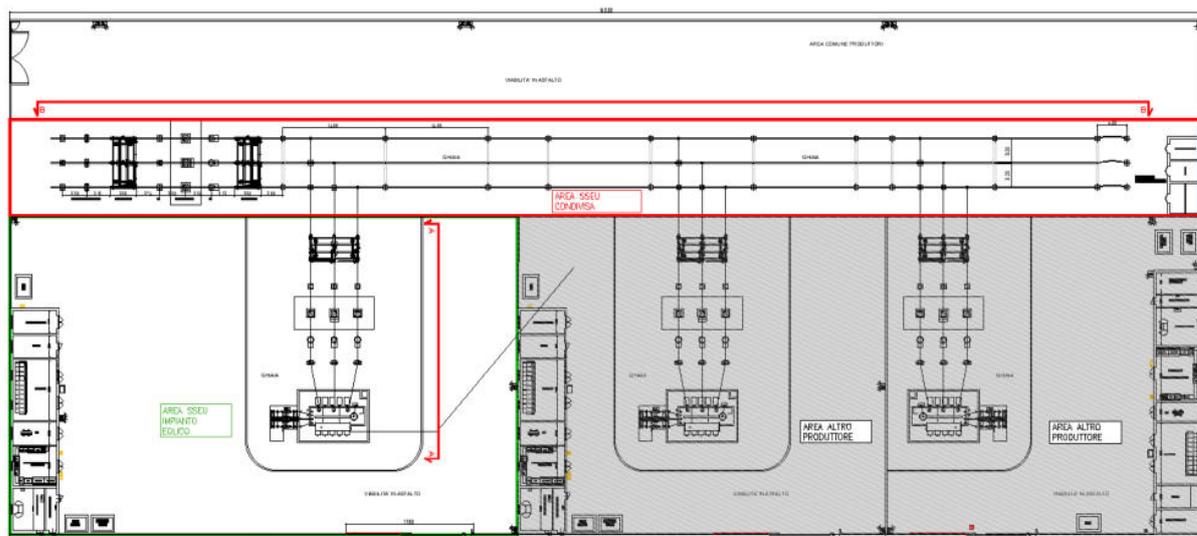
Planimetria elettromeccanica SSE Condivisa
